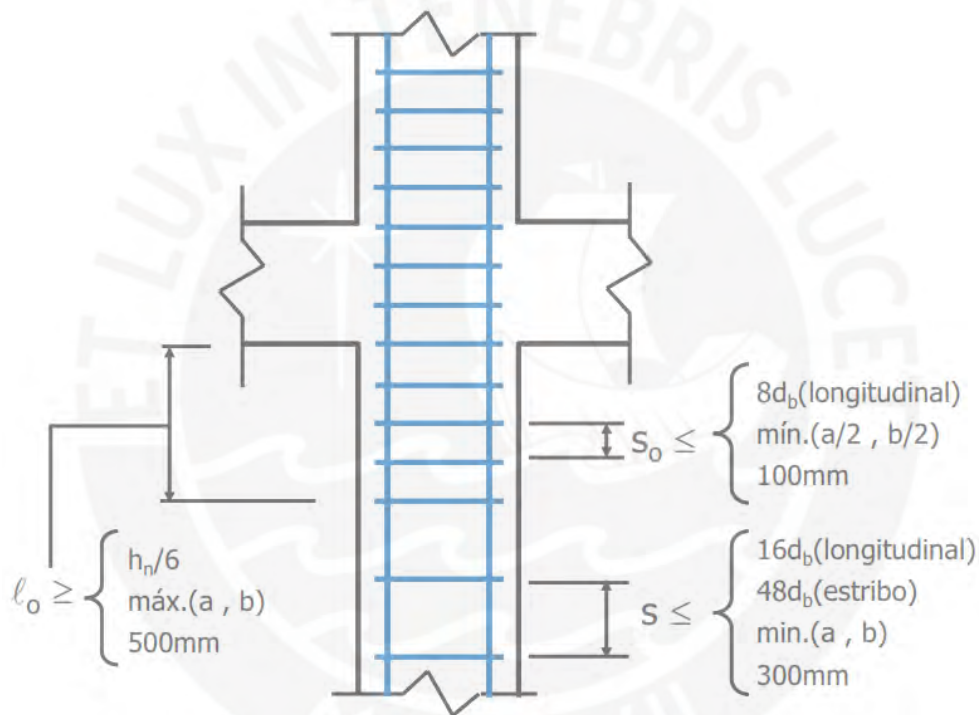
Disposiciones para el diseño sísmico por corte en columnas según la Norma E.060 Tomado de “Diapositivas de clase de Concreto Armado 2”, por Higashi, 2019.
